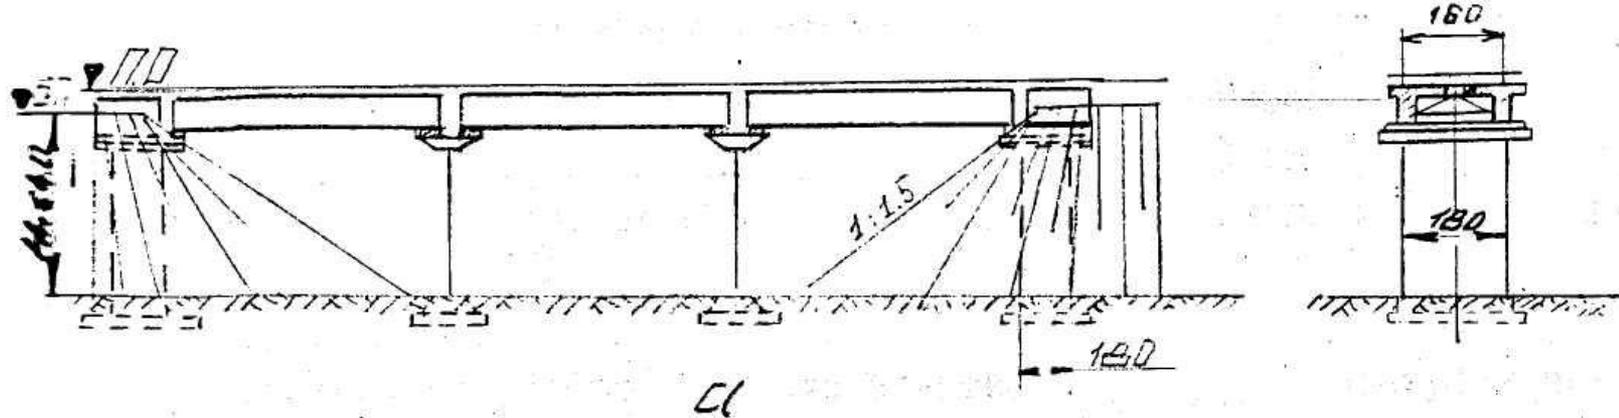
Мосты с железобетонными опорами на подушках.
